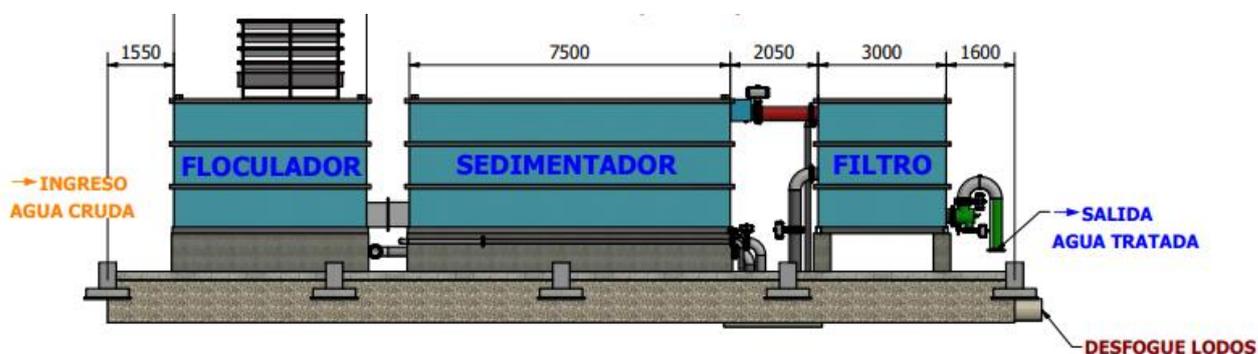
Vista en corte, planta de tratamiento modular 3D
